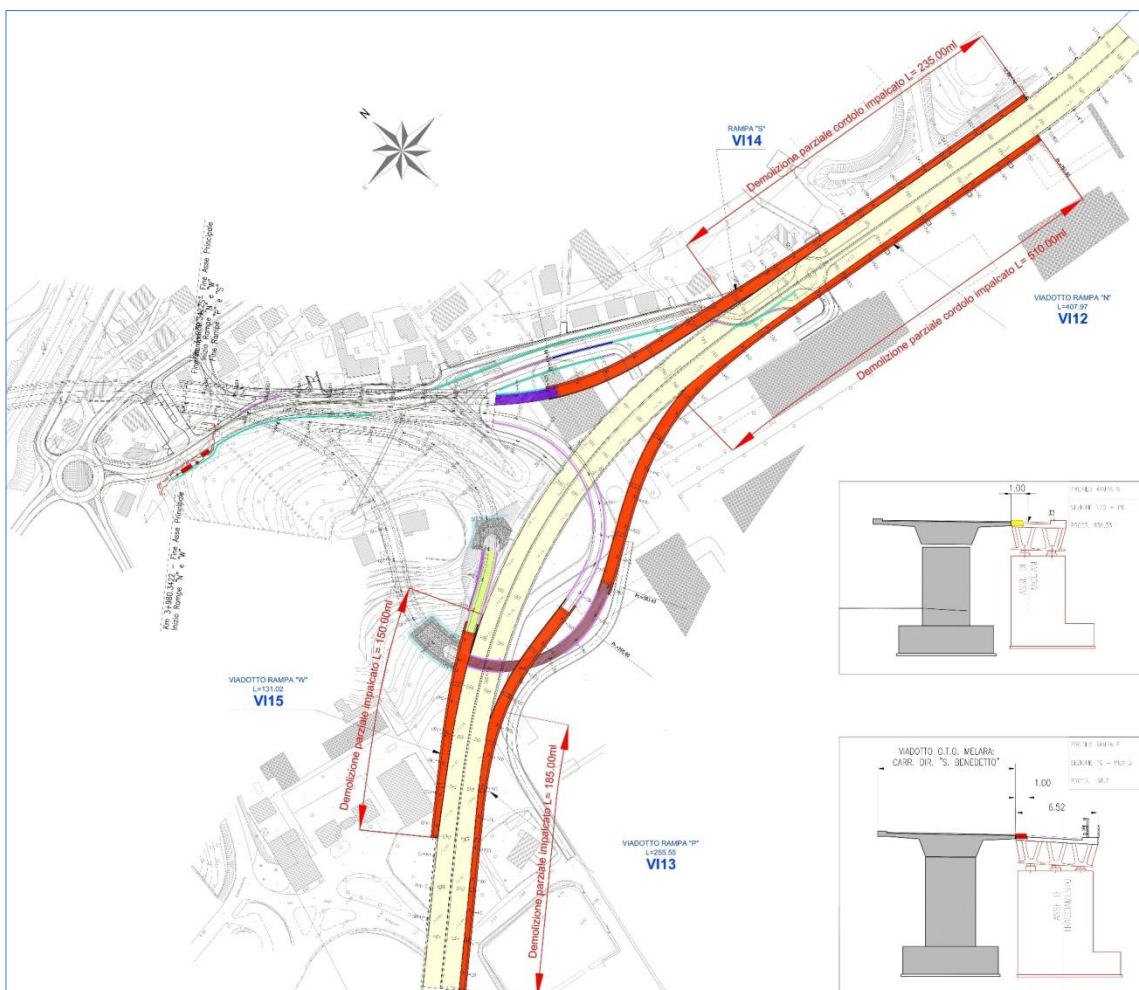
Viadotti Svincolo Melara – Stralcio planimetrico
